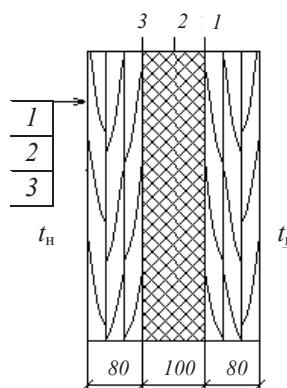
Конструкция стены из двойного клееного бруса со слоем пароизоляции:
